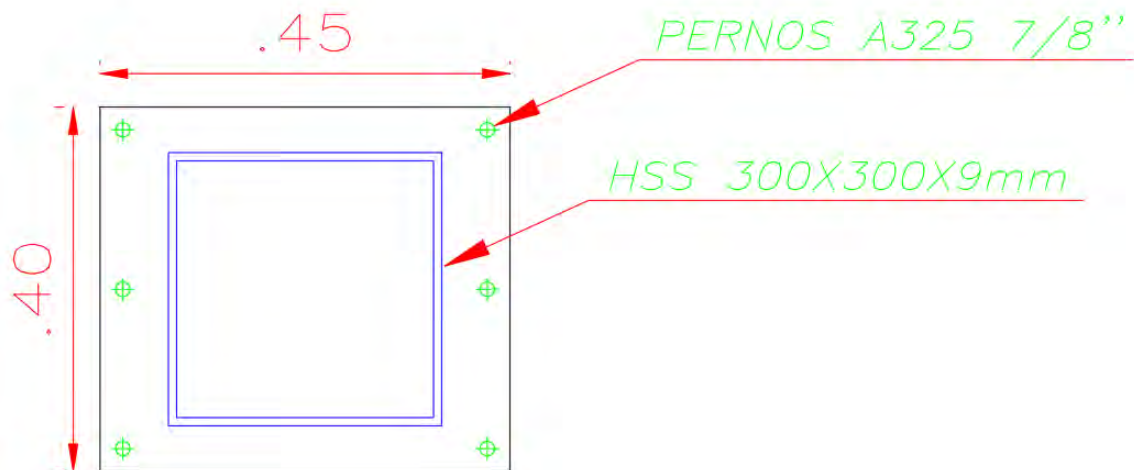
Detalle en planta de plancha base y pernos de anclaje (Fuente: Propia)
